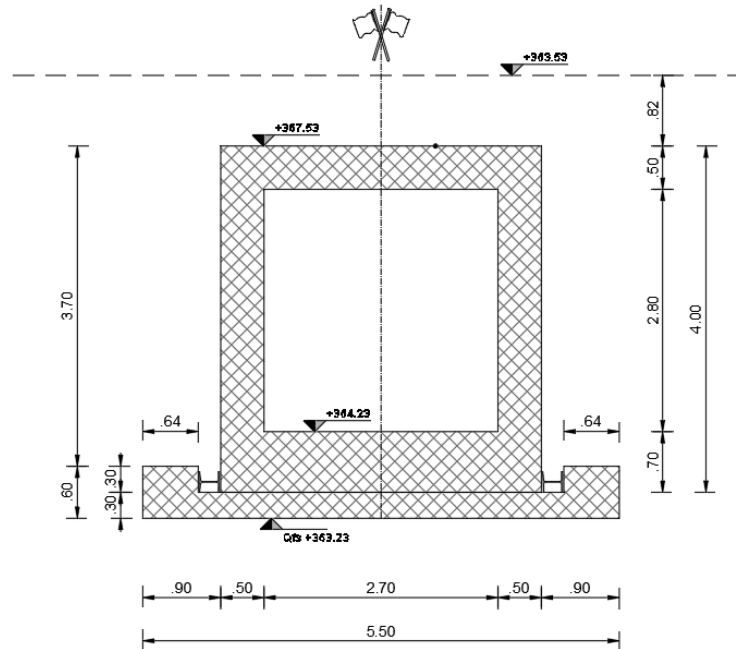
Sezione scatolare del tombino di attraversamento della ferrovia
